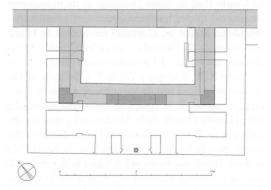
Planta de la zona inferior del Cuarto Real de Santo Domingo de Granada mostrando la planta de la torre primitiva y en silueta la torre más tardía con la *qubba
